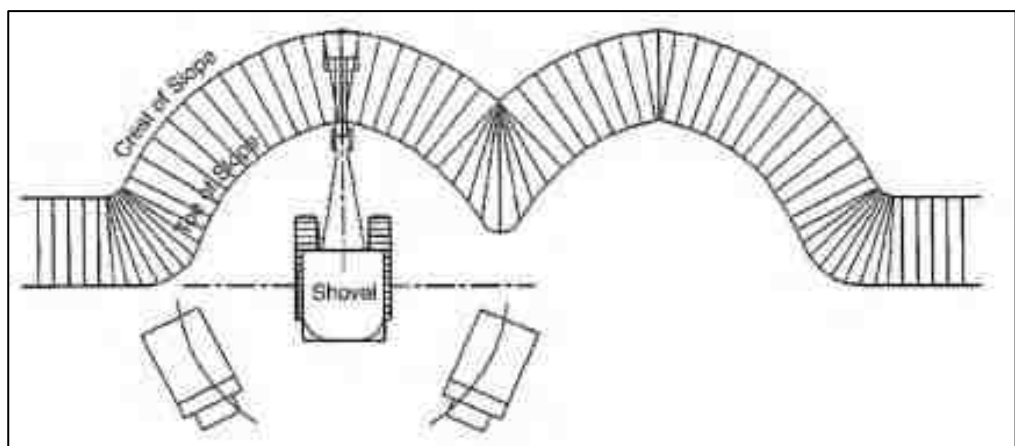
28. Movimiento de Pala en corte Frontal
